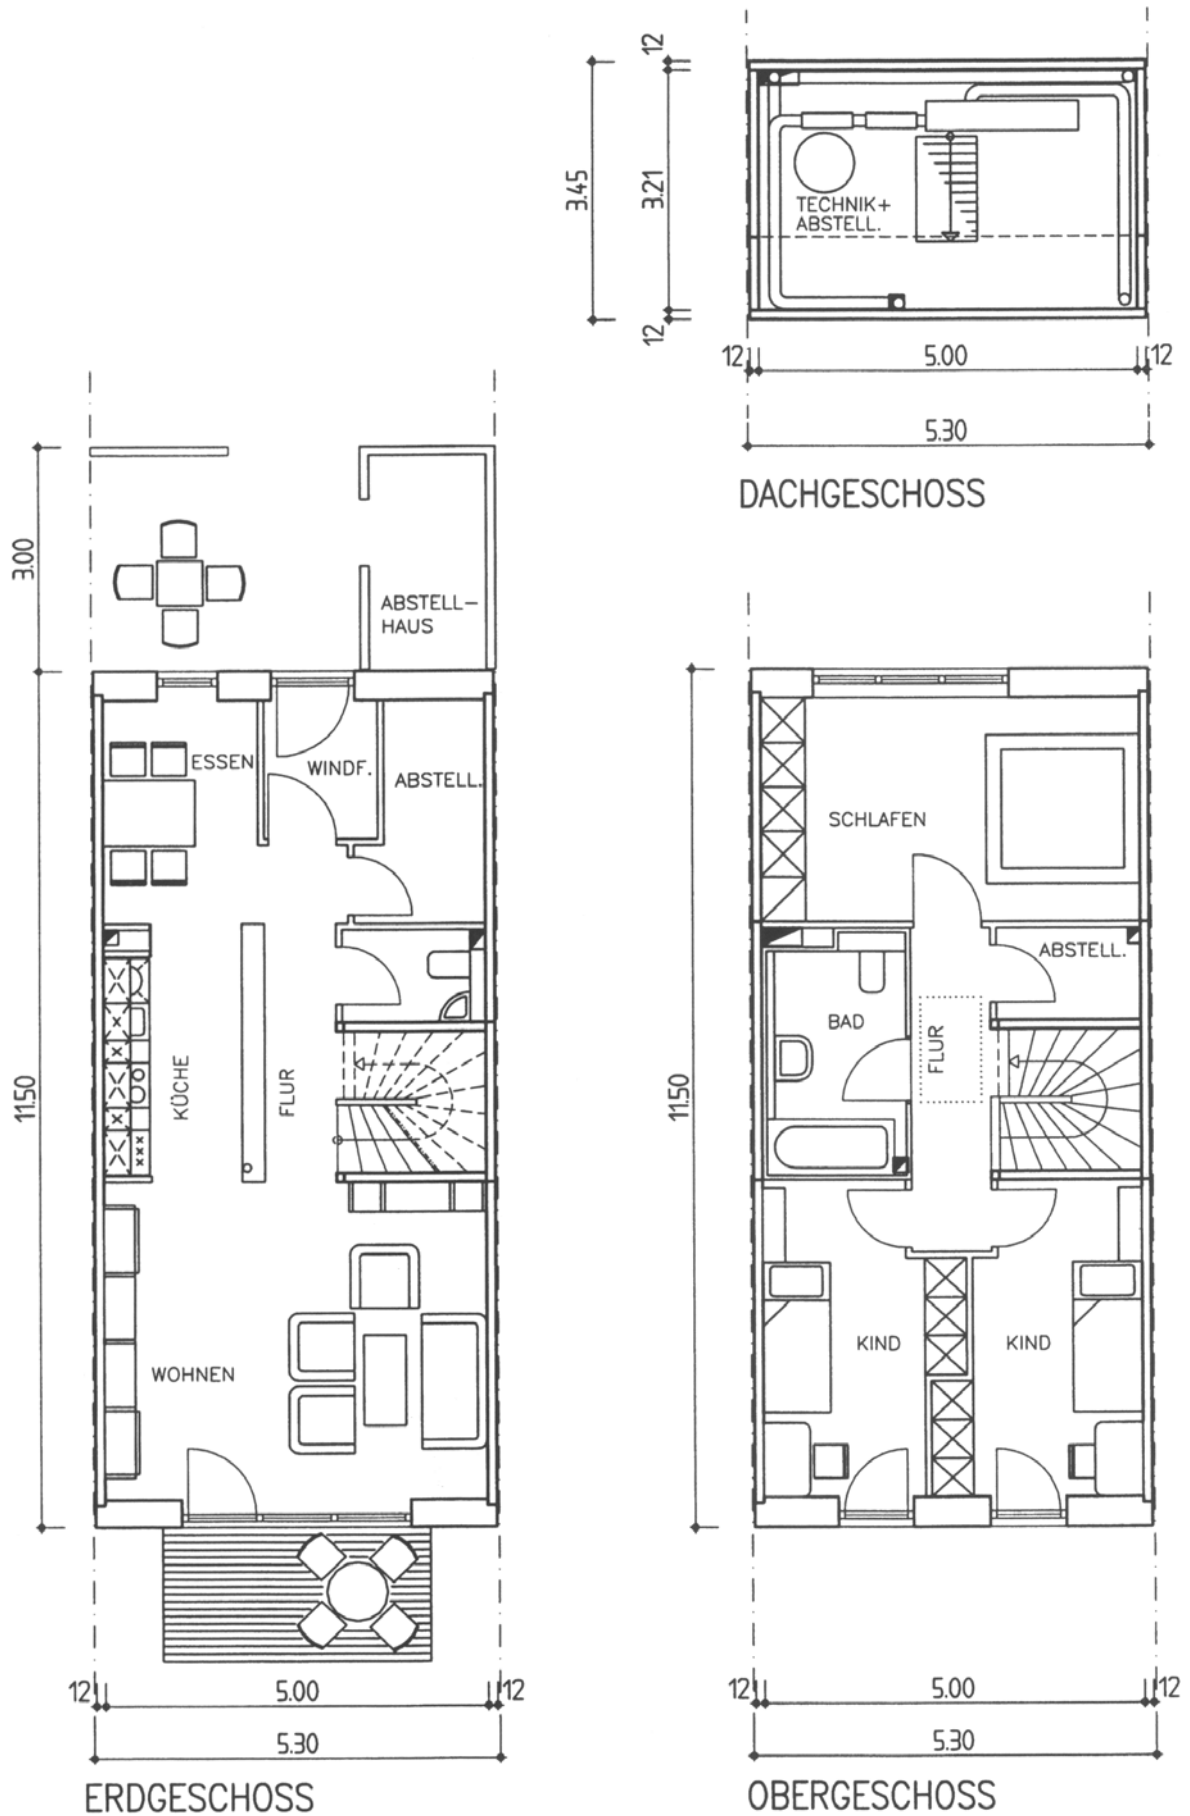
Grundrisse des Hauses vom Typ Jangster (Passivhäuser Kronsberg)
